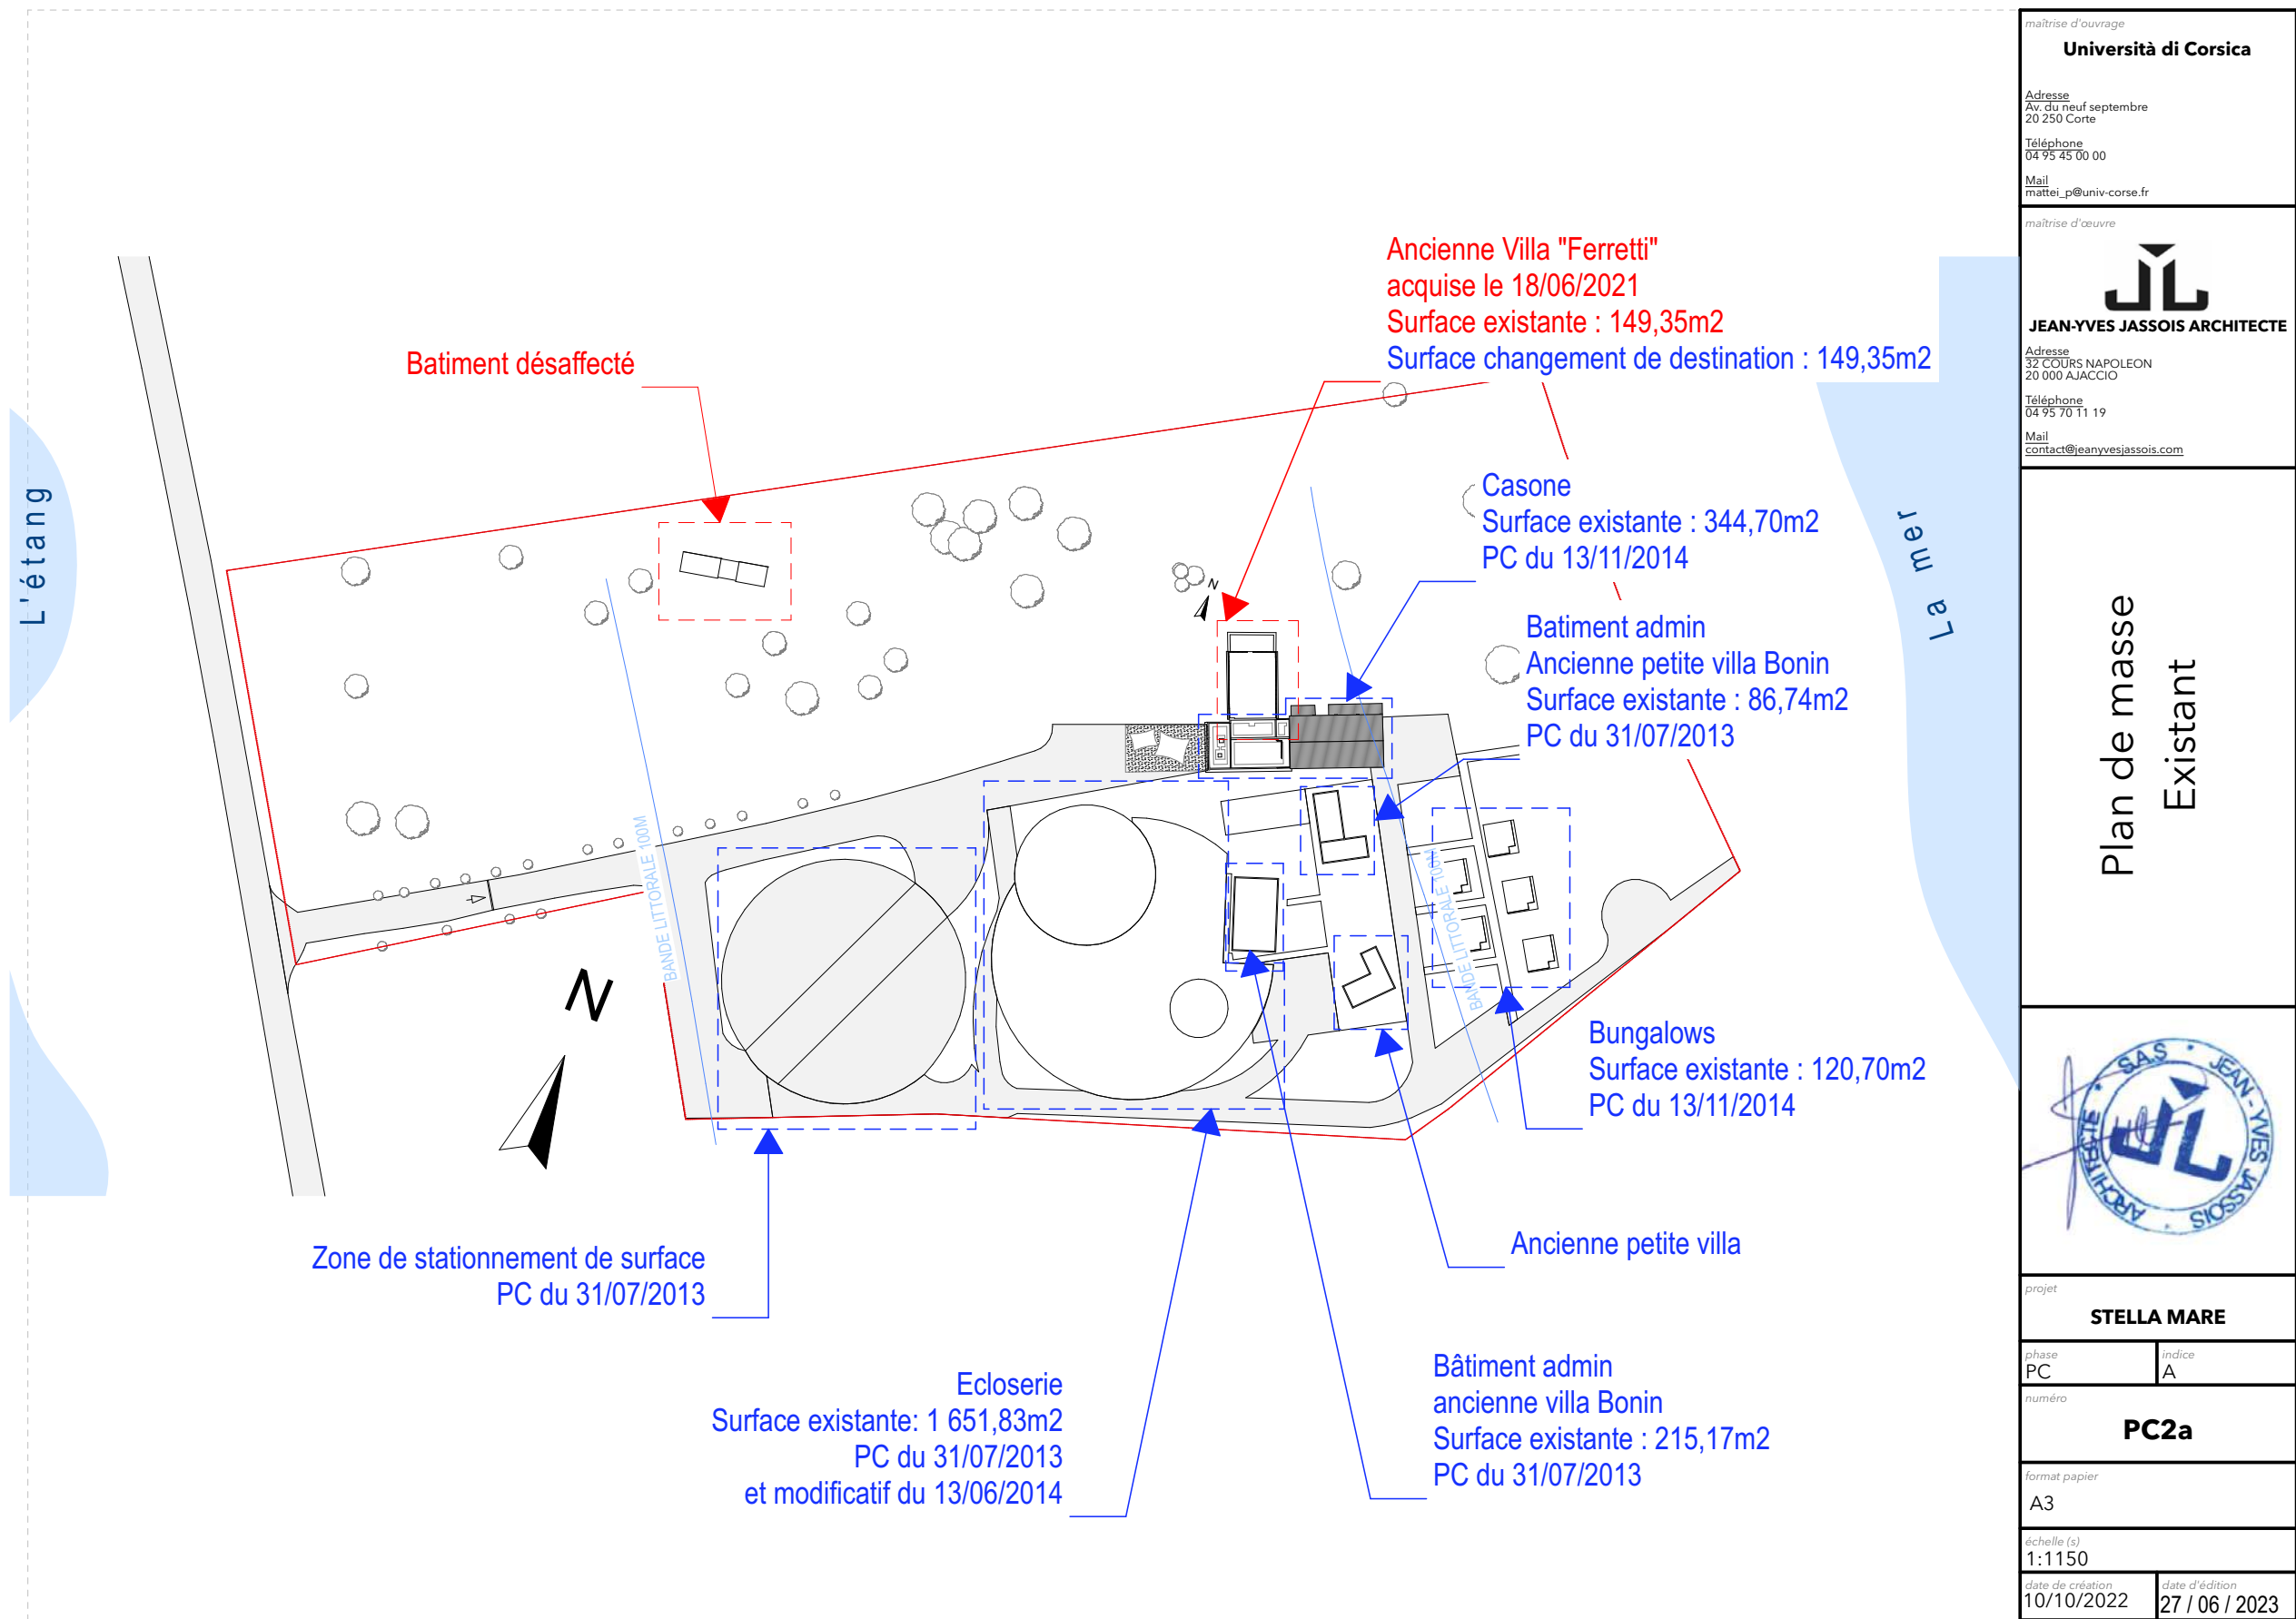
Plan de masse de l'existant (Source : Jean-Yves Jassois Architecte)
